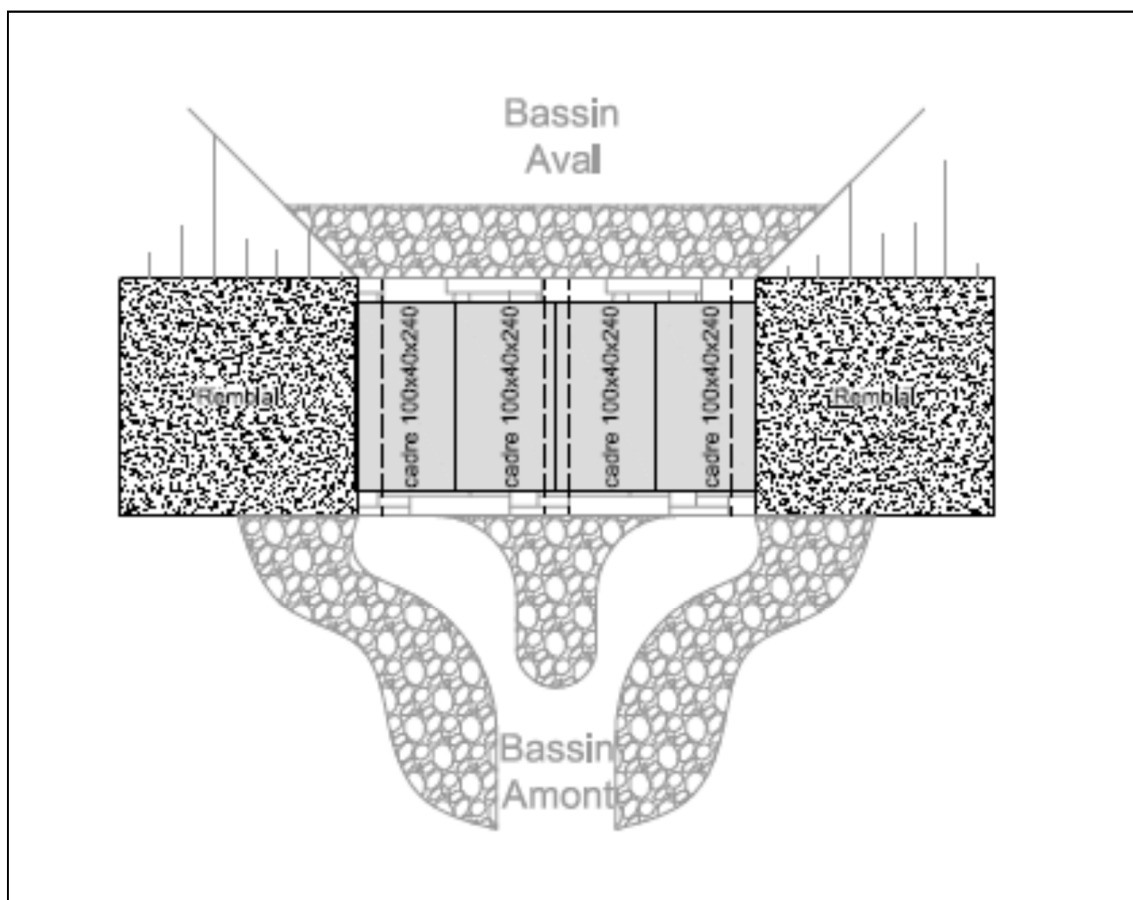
Vue en plan sur busage du chemin (par Omnitech)
